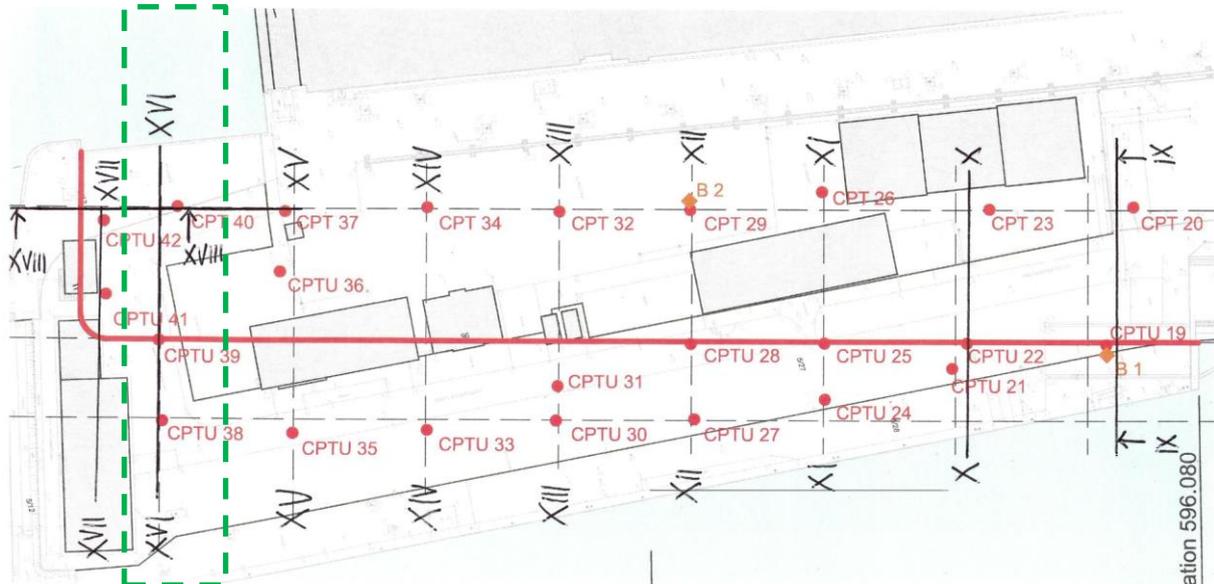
Bemessungsprofil XVI - Lage [U1]
